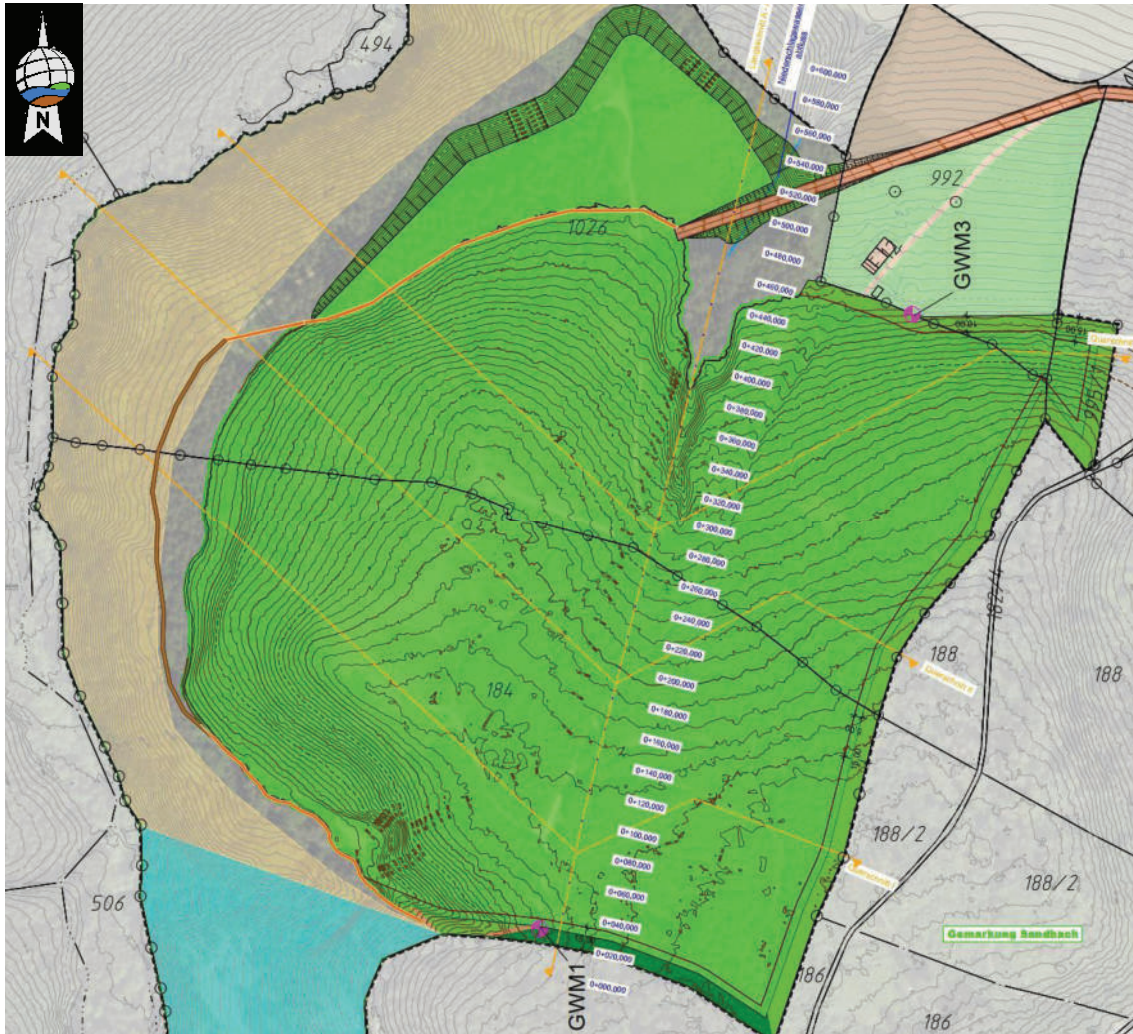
Darstellung der Abstands- und Betriebsflächen des Tagebauareals; Quelle: Geoplan GmbH - Stand 03/2024; unmaßstäblich
